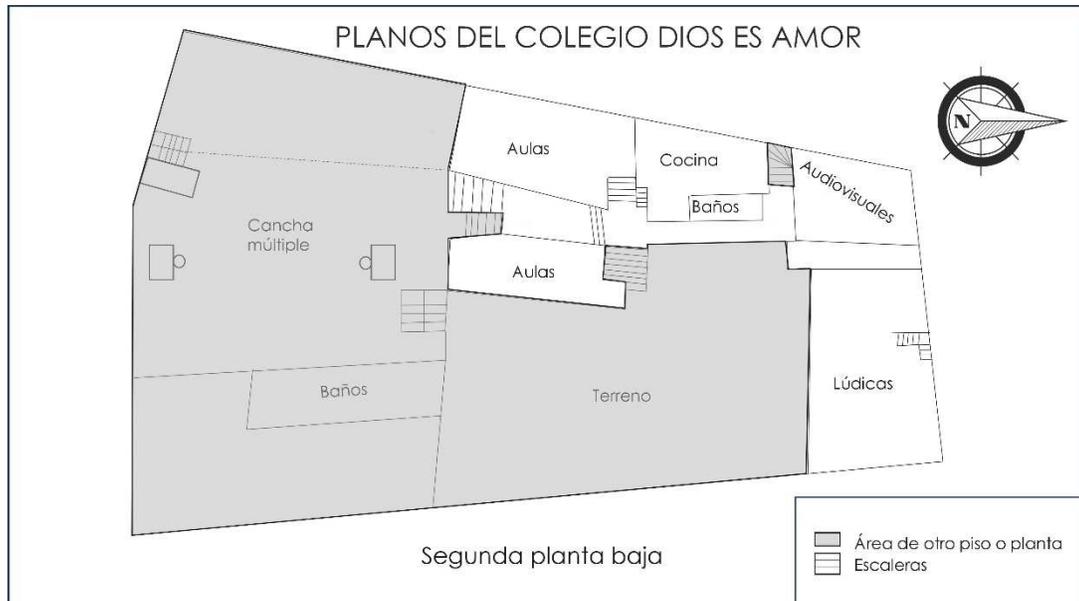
Plano 3: Segunda planta baja. Fuente: IEEE, 2017.
